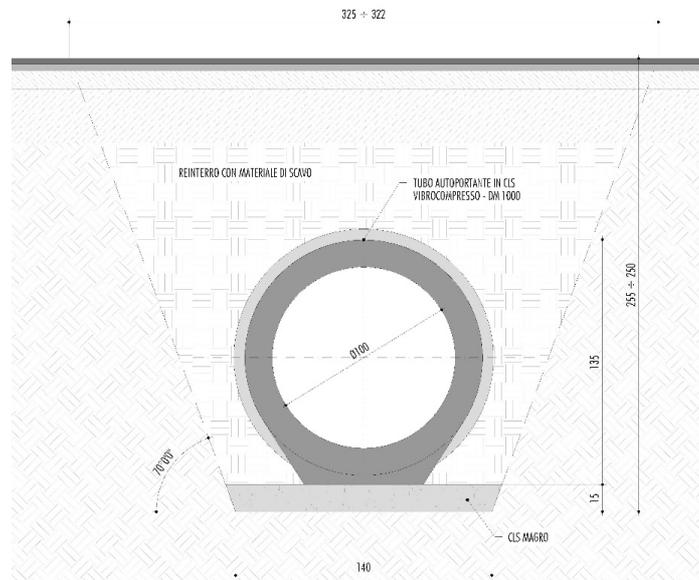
SEZIONE TIPO ATTRAVERSAMENTI IDRAULICI
